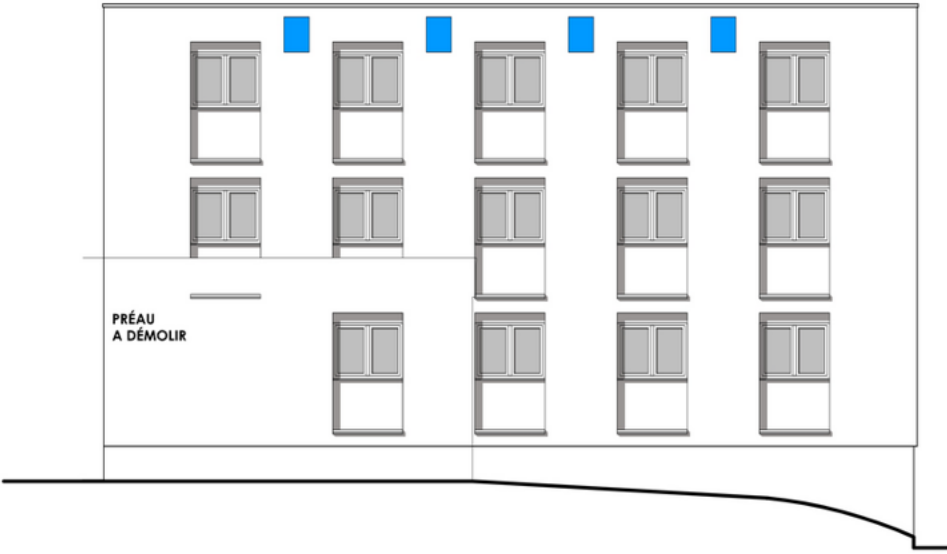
Localisation des gîtes compensatoires sur le bâtiment externat - façade sud
